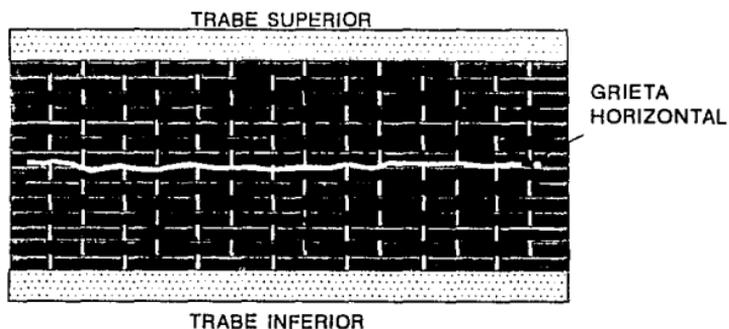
GRIETA HORIZONTAL POR CONTRACCION DE LOS BLOQUES DE CONCRETO
